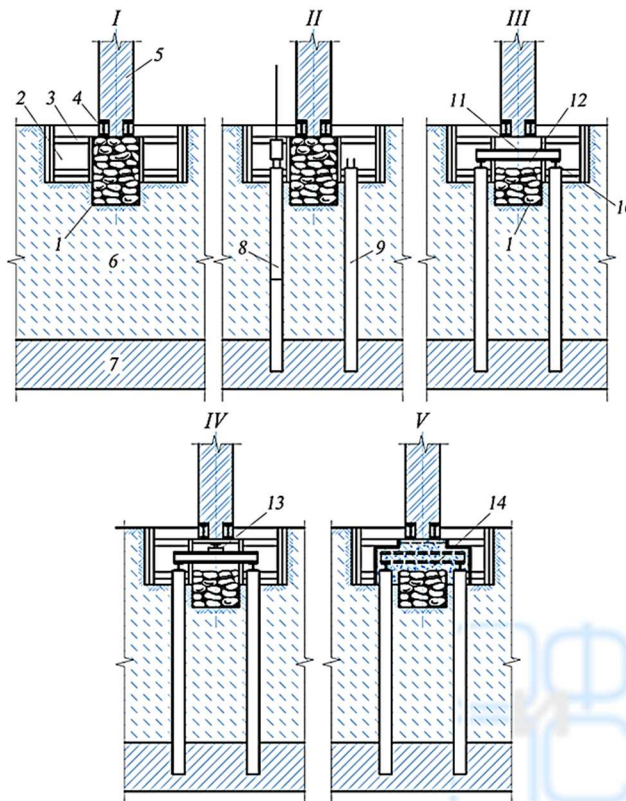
Этапы работ по усилению ленточных фундаментов набивными сваями:
